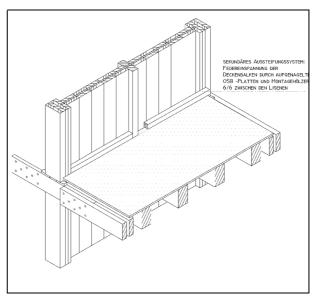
Rohbau Knoten Wand – Decke mit Skelettstütze
